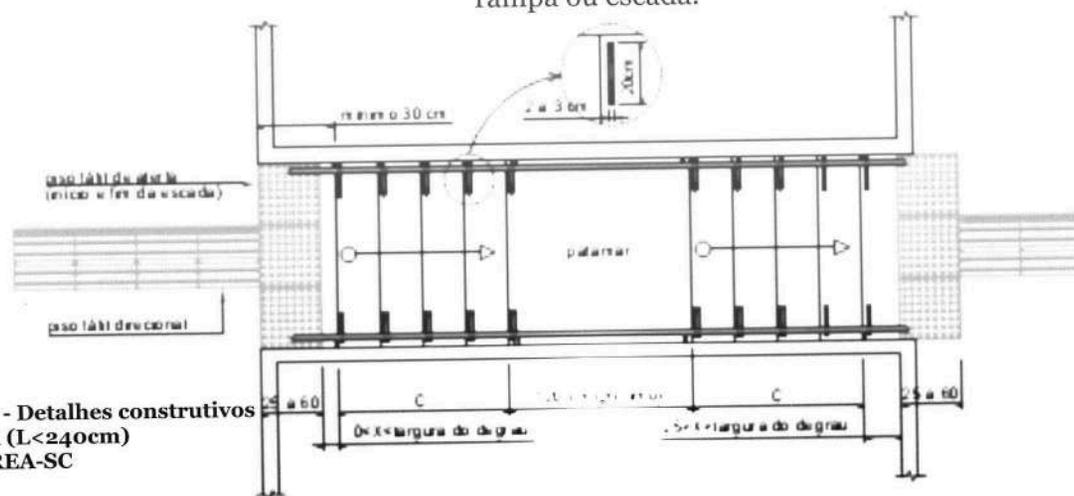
Detalhes construtivos de escada (L < 240cm)
